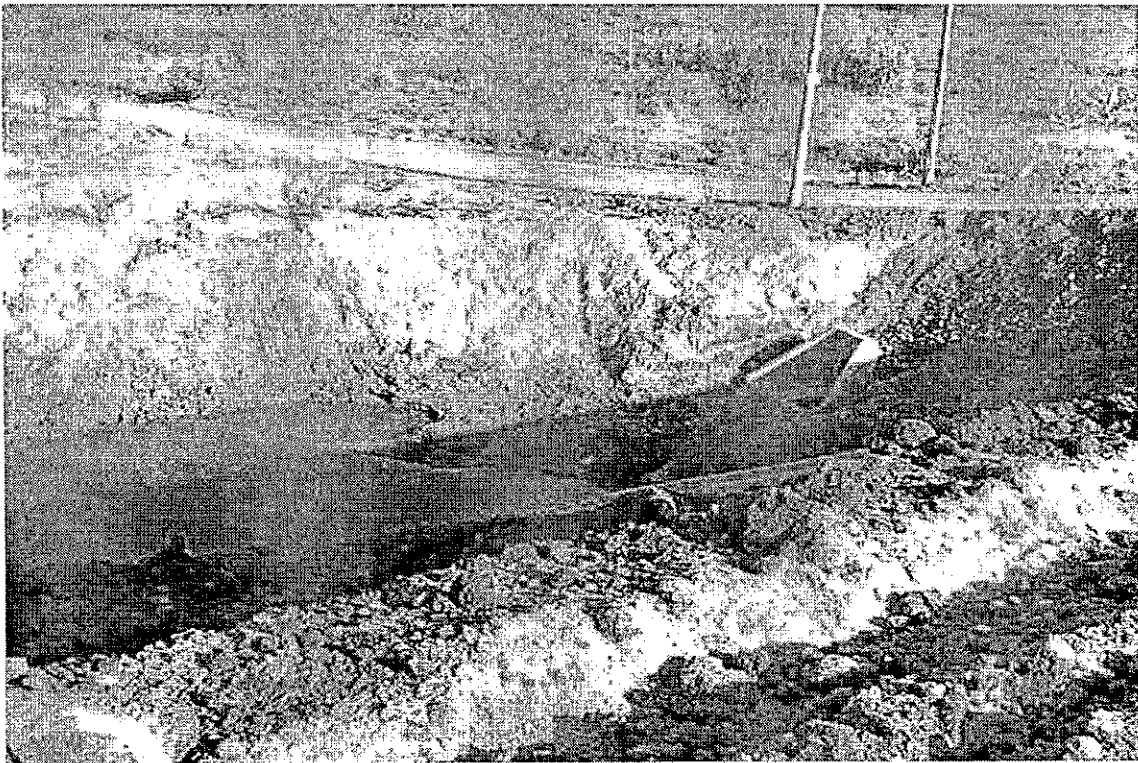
Vista do bueiro no km 383,680 já desobstruído.
